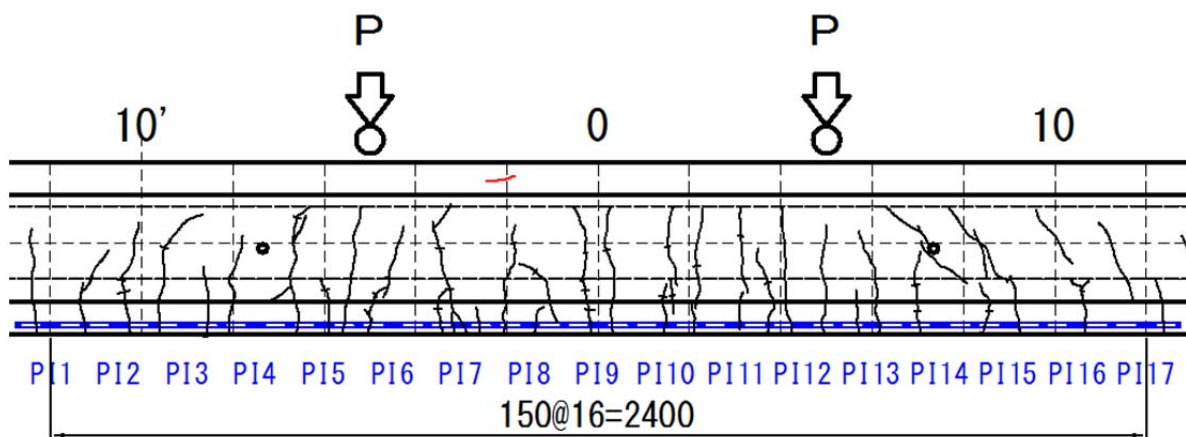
90kN 載荷時 桁側面ひび割れ図
